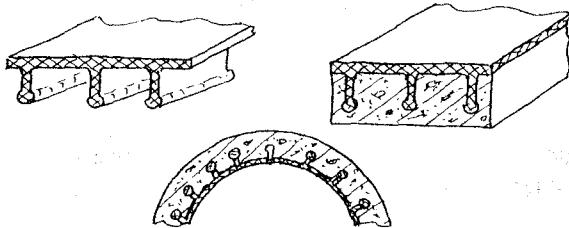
Использование полиэтиленового листа с армированными ребрами в различных конструкциях
